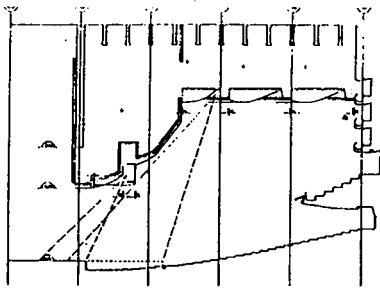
Coupe longitudinale - Plafond position Opéra
